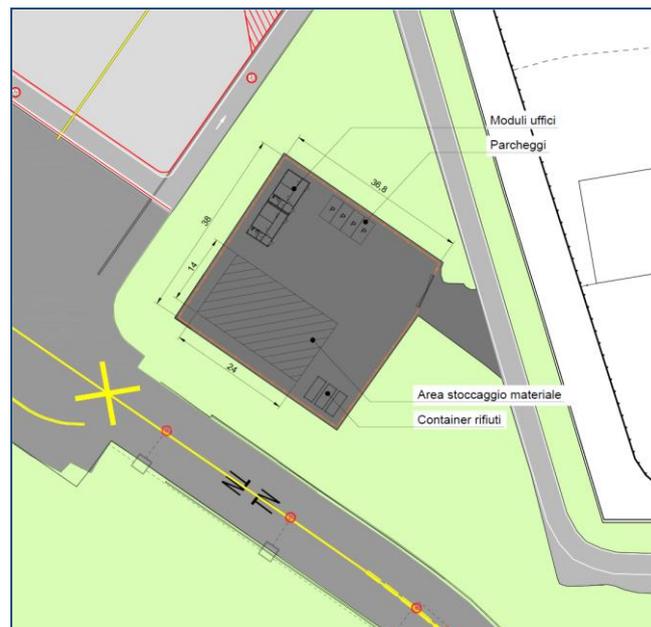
Area di cantiere (Fase 0 e Fase 1).
